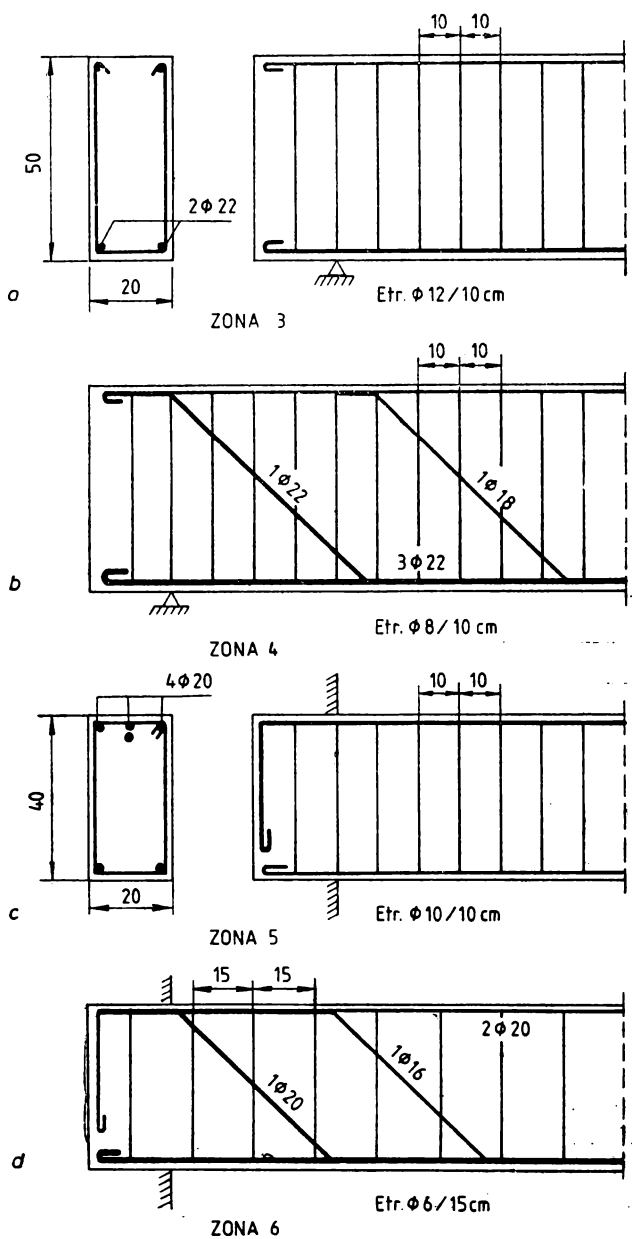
Soluții de armare transversală a grinzilor :
